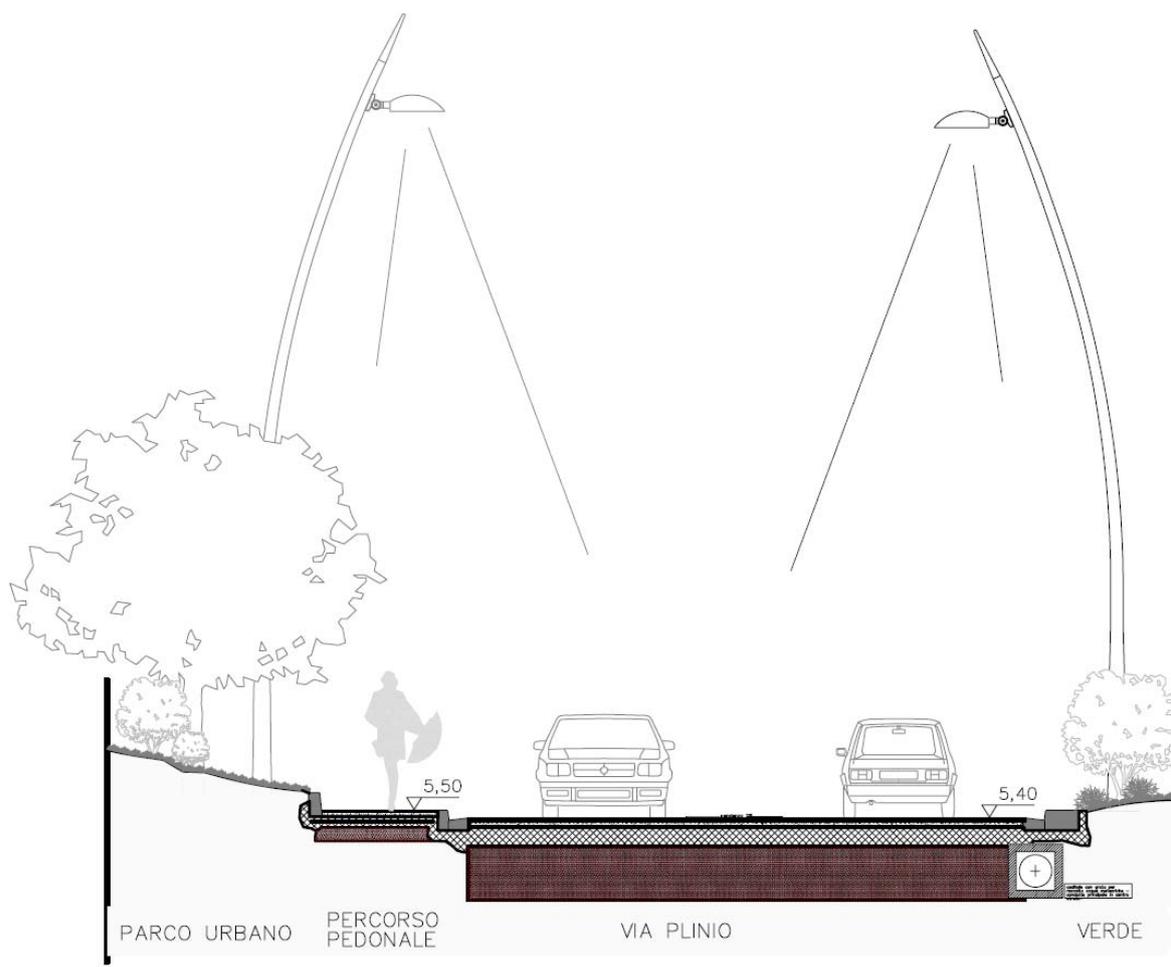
Sezione stradale con esempio di sistemazione dei corpi illuminanti
